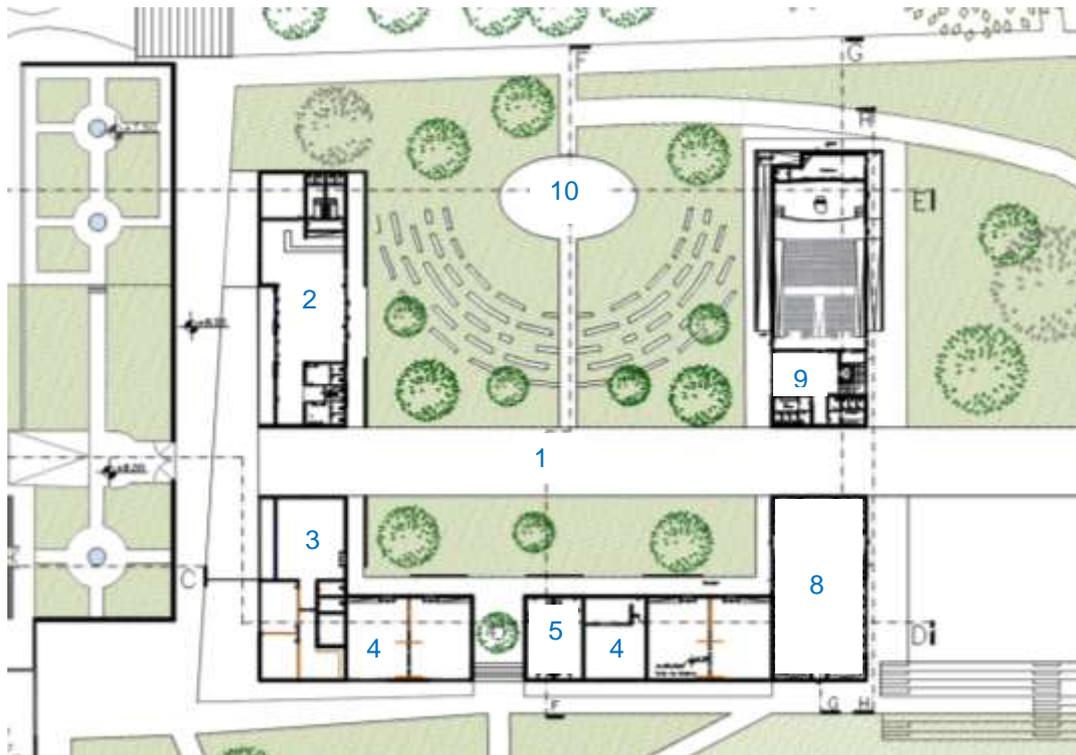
Planta piso 0 do Edifício Proposta – Centro Cultural - sem escala (Fonte: autor, 2017)
